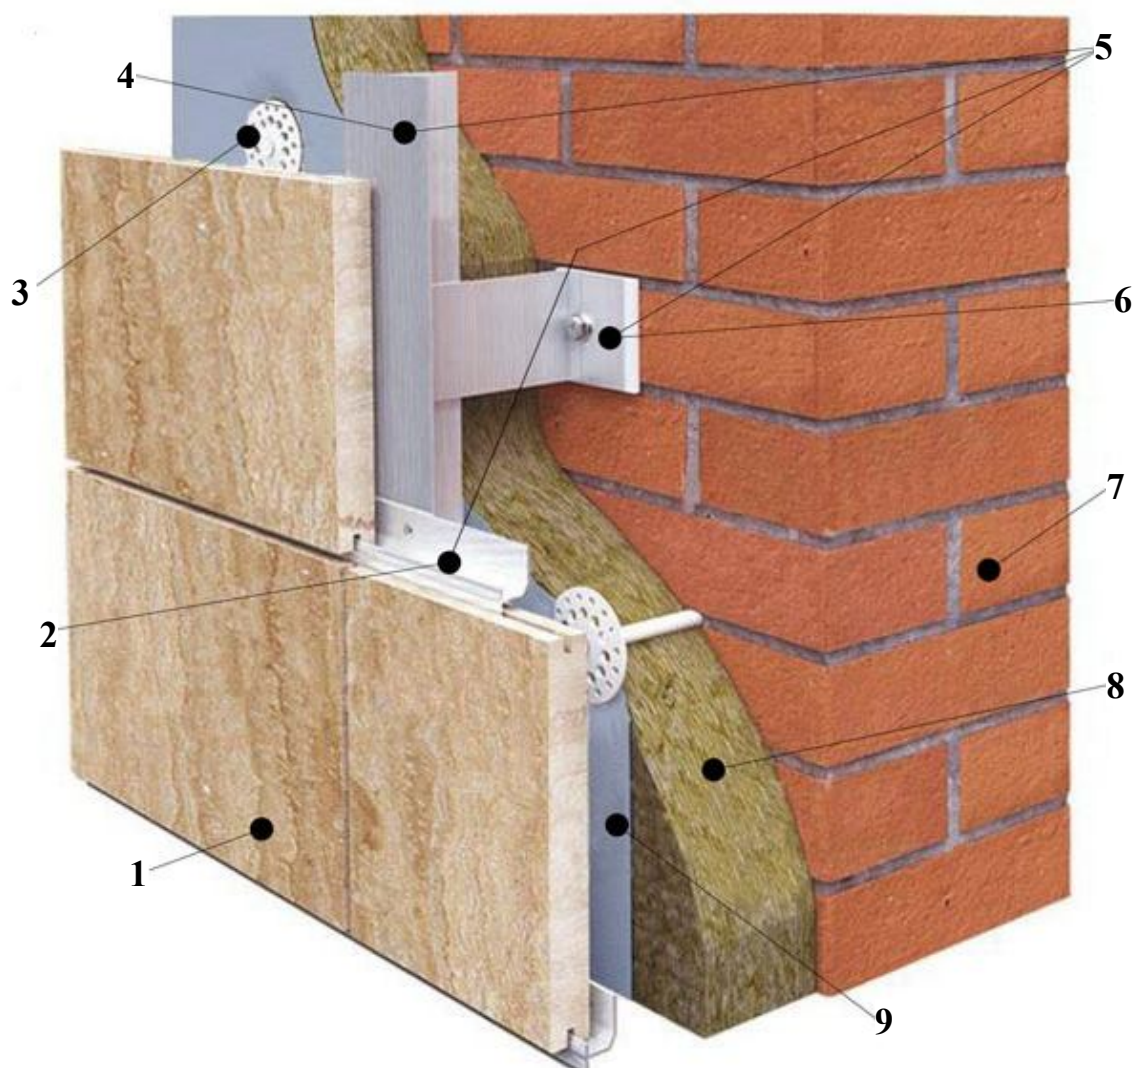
Навісна фасадна система: 1 – плита фасадна; 2 – напрямна горизонтальна; 3 – тарілчастий дюбель; 4 – напрямна вертикальна; 5 – металокаркас; 6 – кронштейн стінний; 7 – стіна будівлі; 8 – утеплювач; 9 – пароізолювальна мембрана
